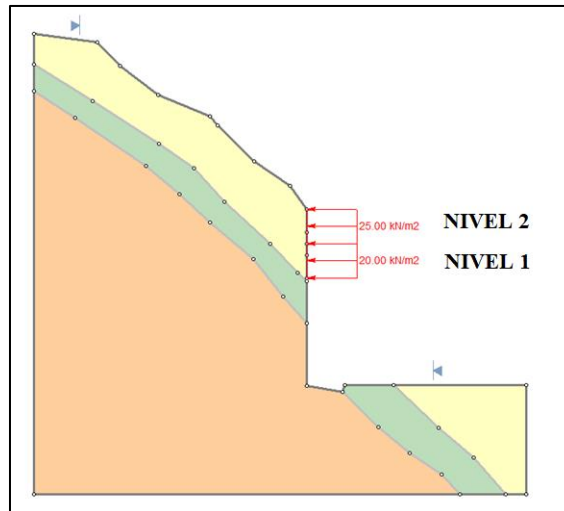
Configuración de cargas para el panel 1. Fuente: Propia
